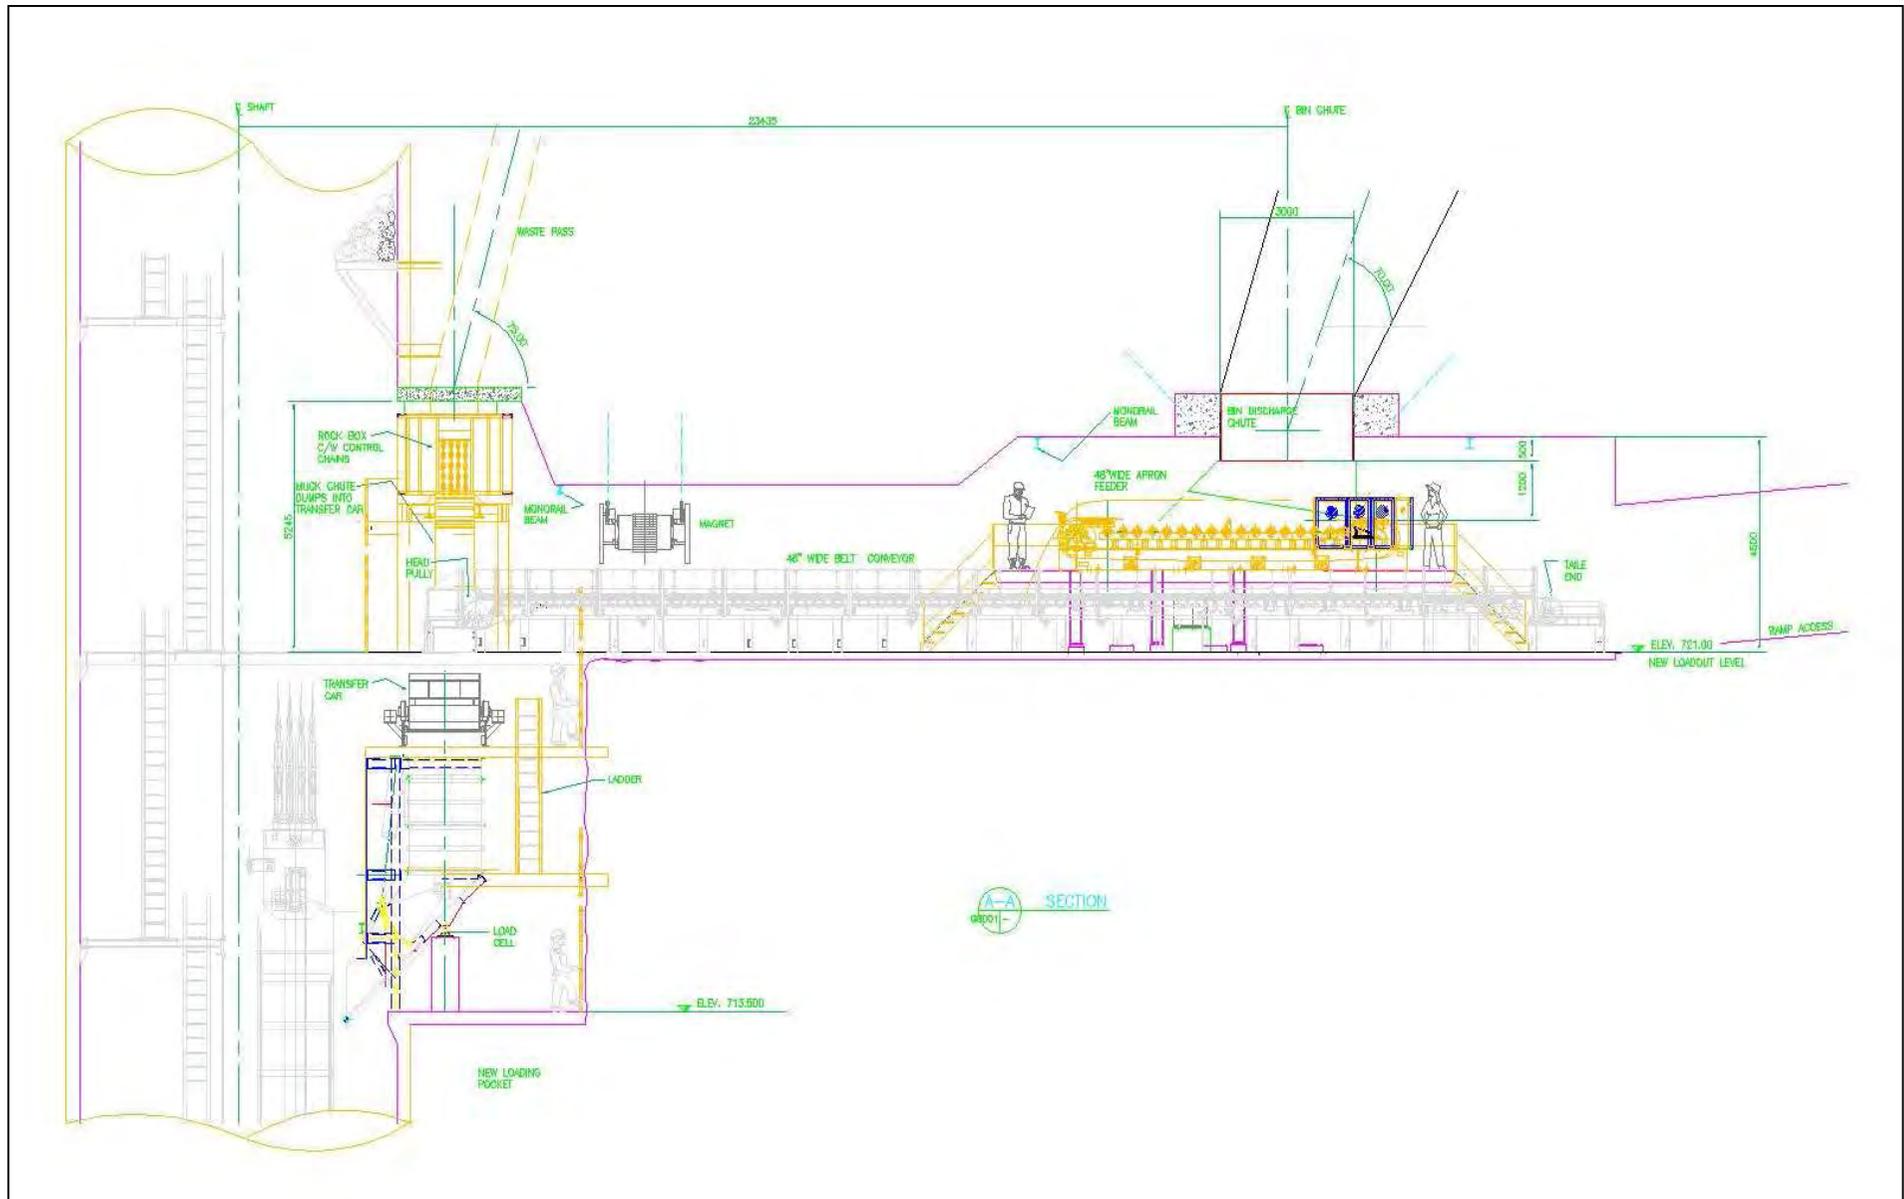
Sección transversal de la banda de cargado y parte inferior de la tolva de finos.
